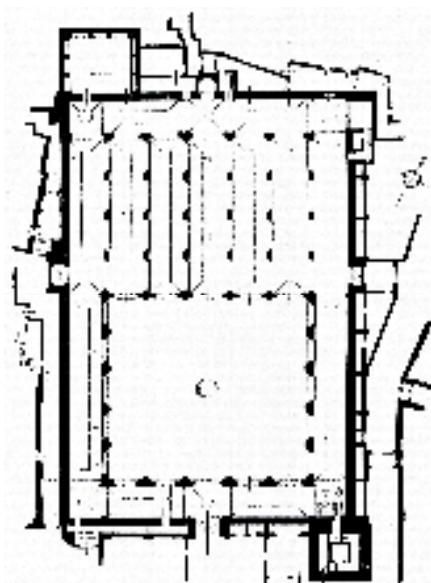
مسقط أفقى لجامع المنصور بقصبة مراكش.
